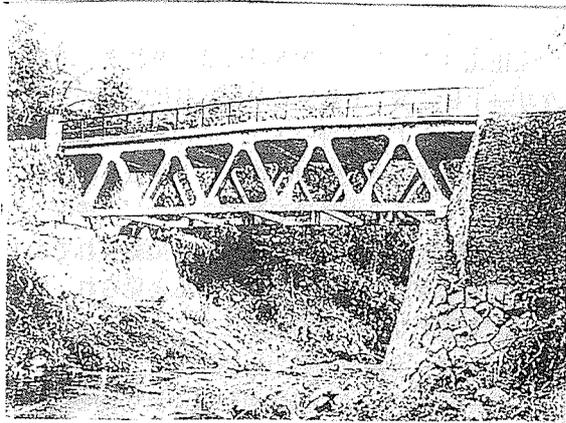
上川口橋の鉄筋コンクリート橋脚施工状況¹⁷⁾(明治45年3月)
